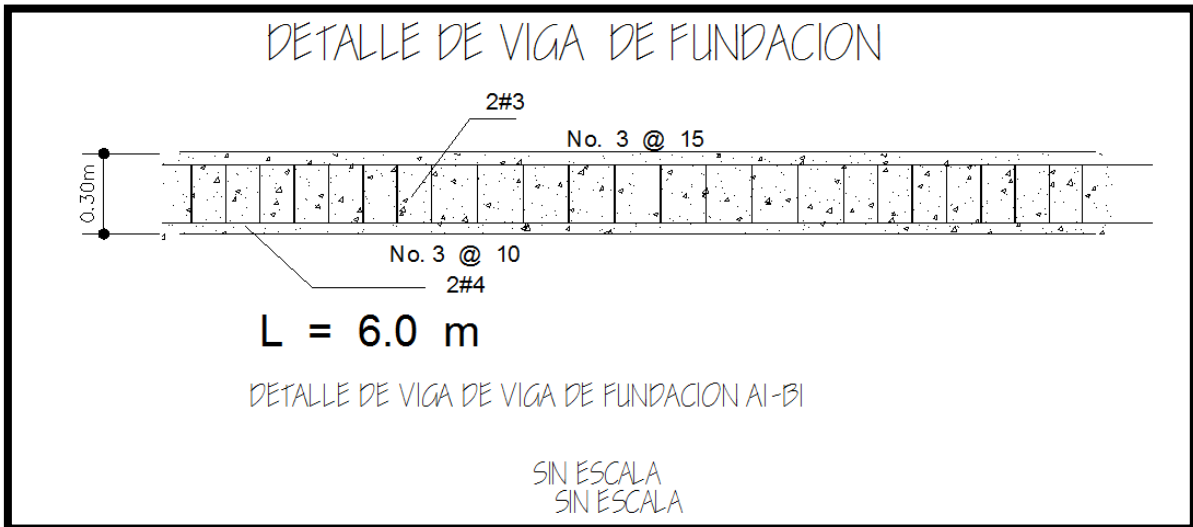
Perfil de viga con distribucion del acero de refuerzo.
